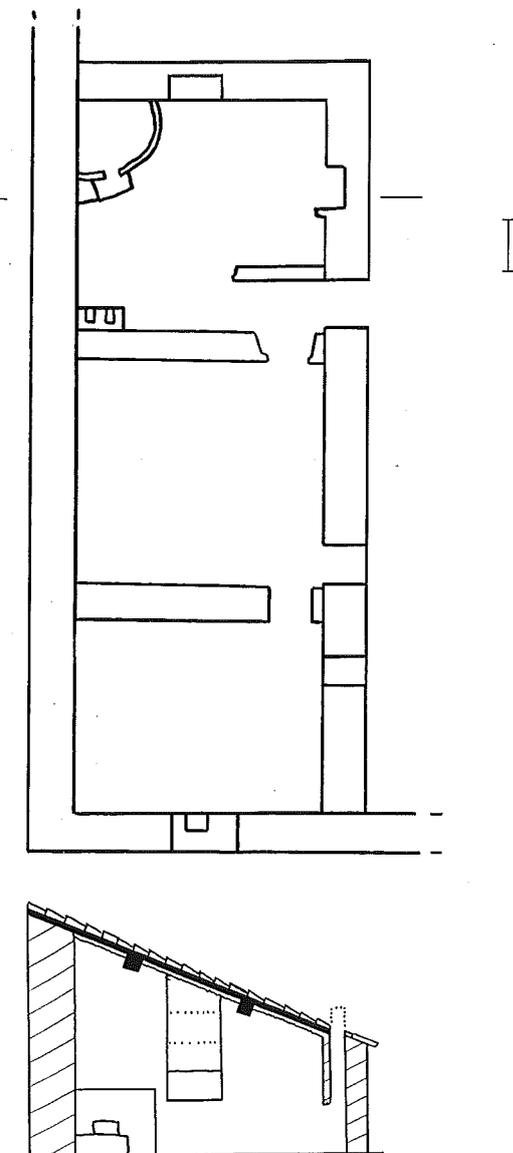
Maison rurale à Bisarcio: plan et coupe (relevé fouilles d'Urvei).
